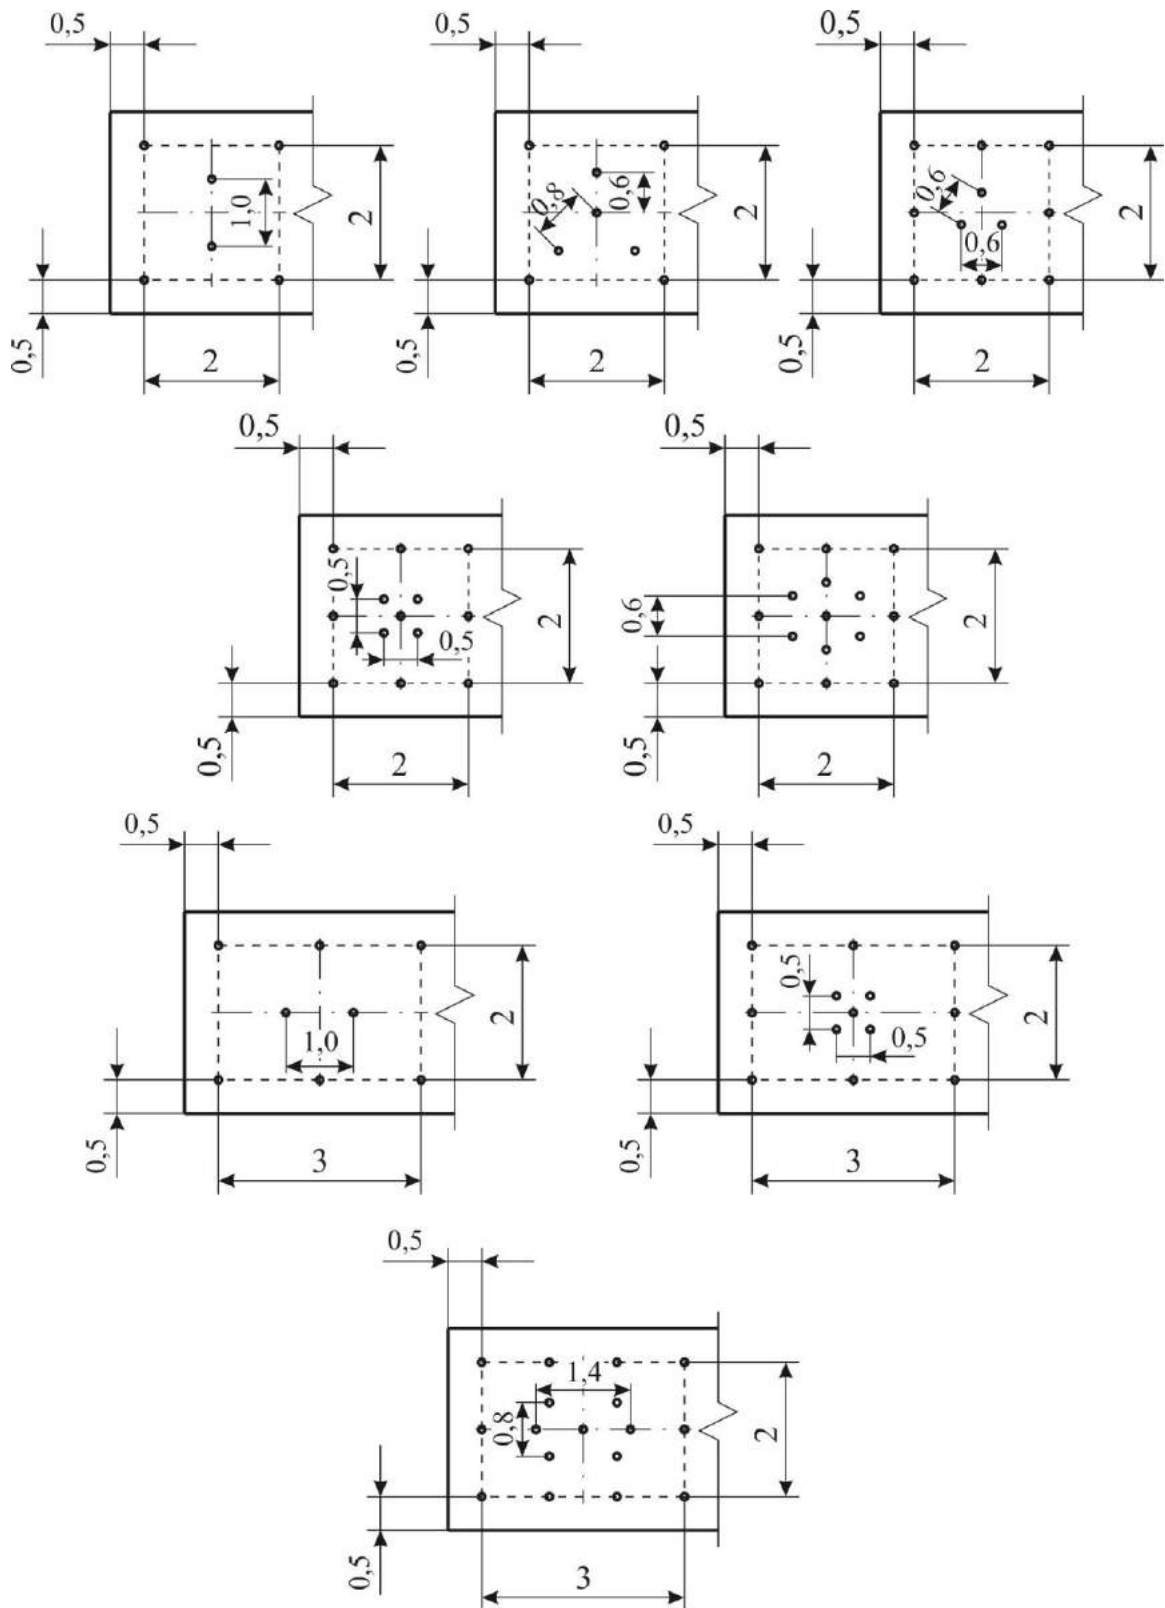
Схеми розташування свердловин у вибої підняттевого
